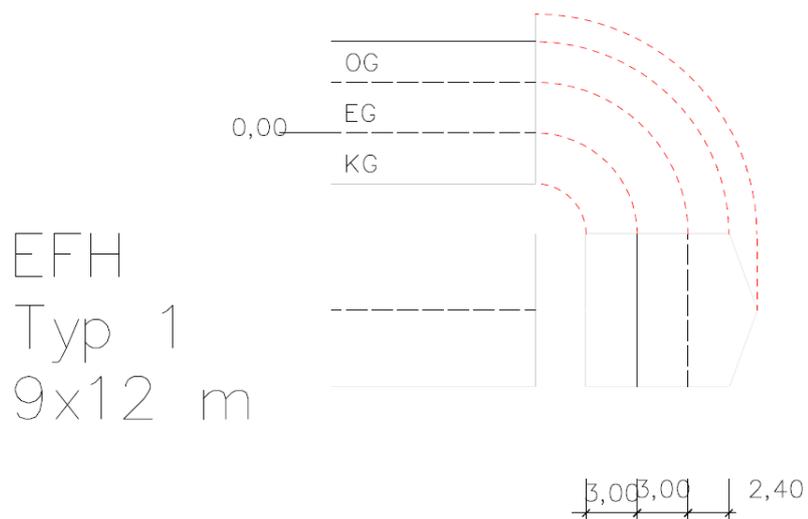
Einfamilienhausbebauung Typ 1, Planung: Büro f64
